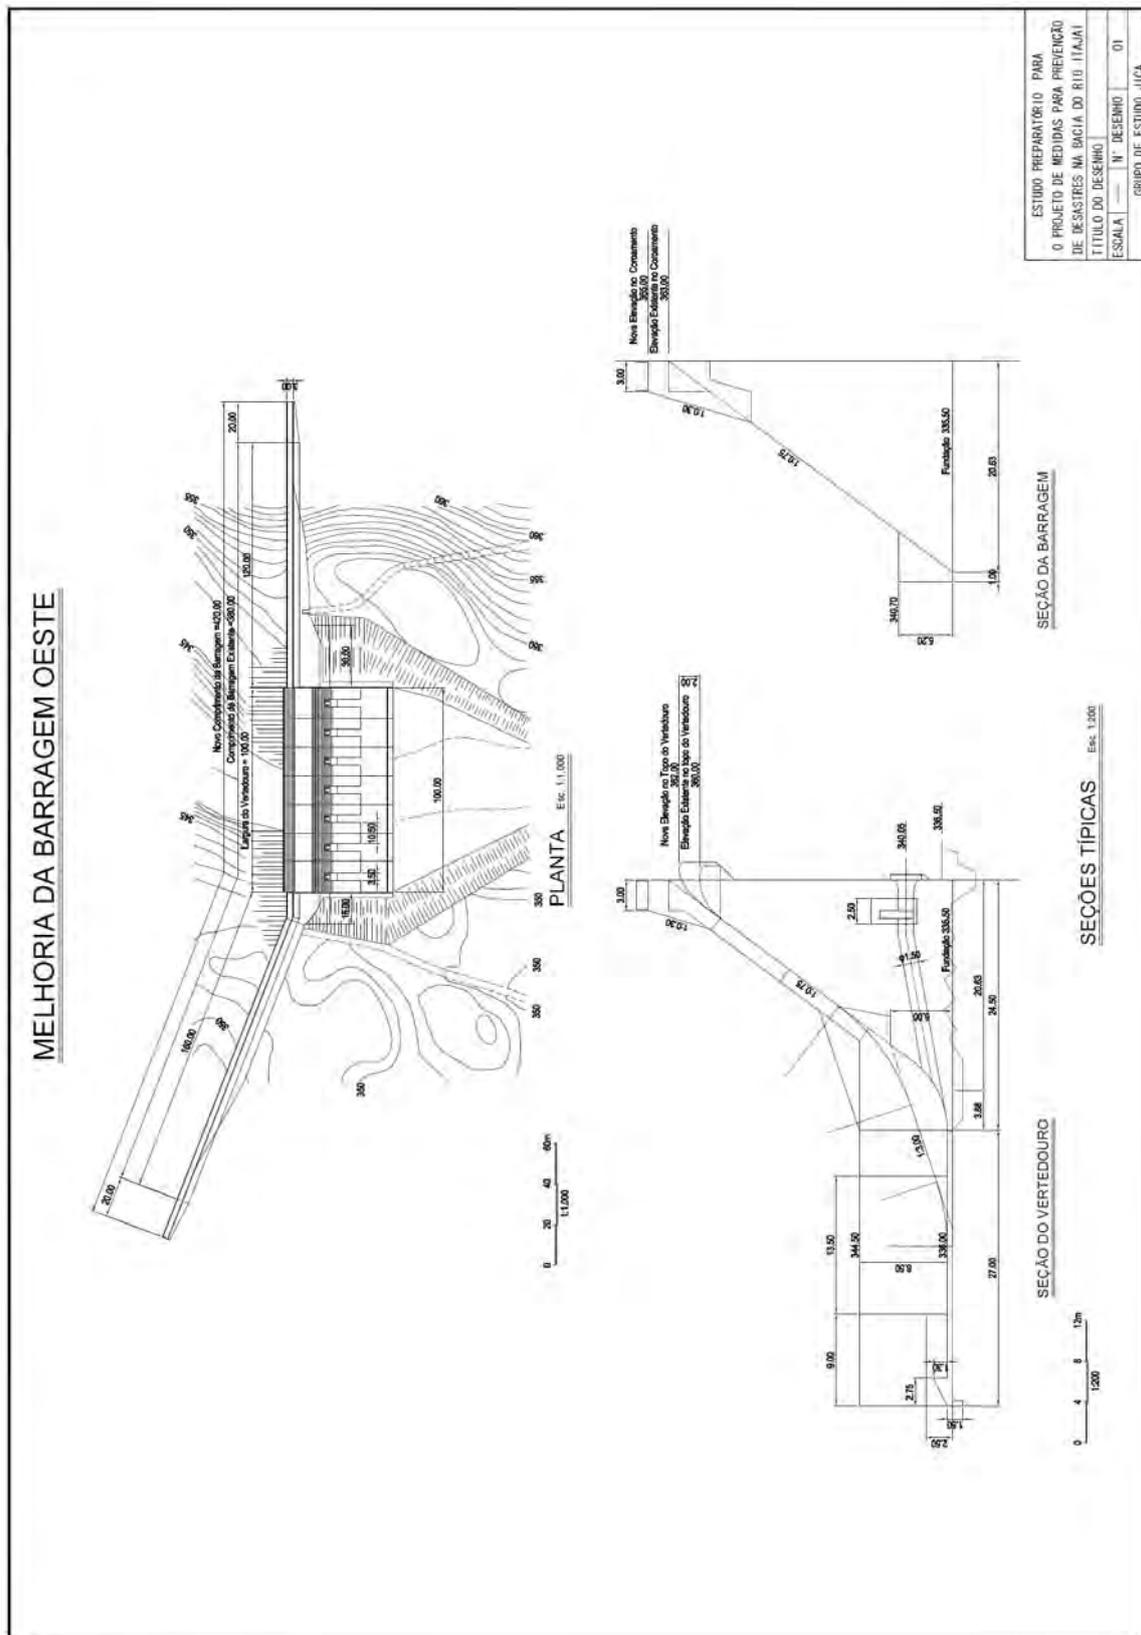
Desenho estrutural da sobre-elevação da barragem Oeste
